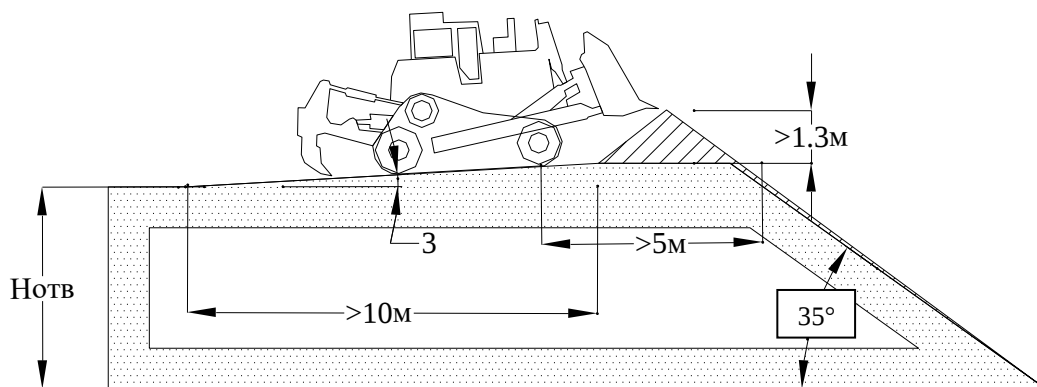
Формирование разгрузочной площадки отвала бульдозером SD-22
